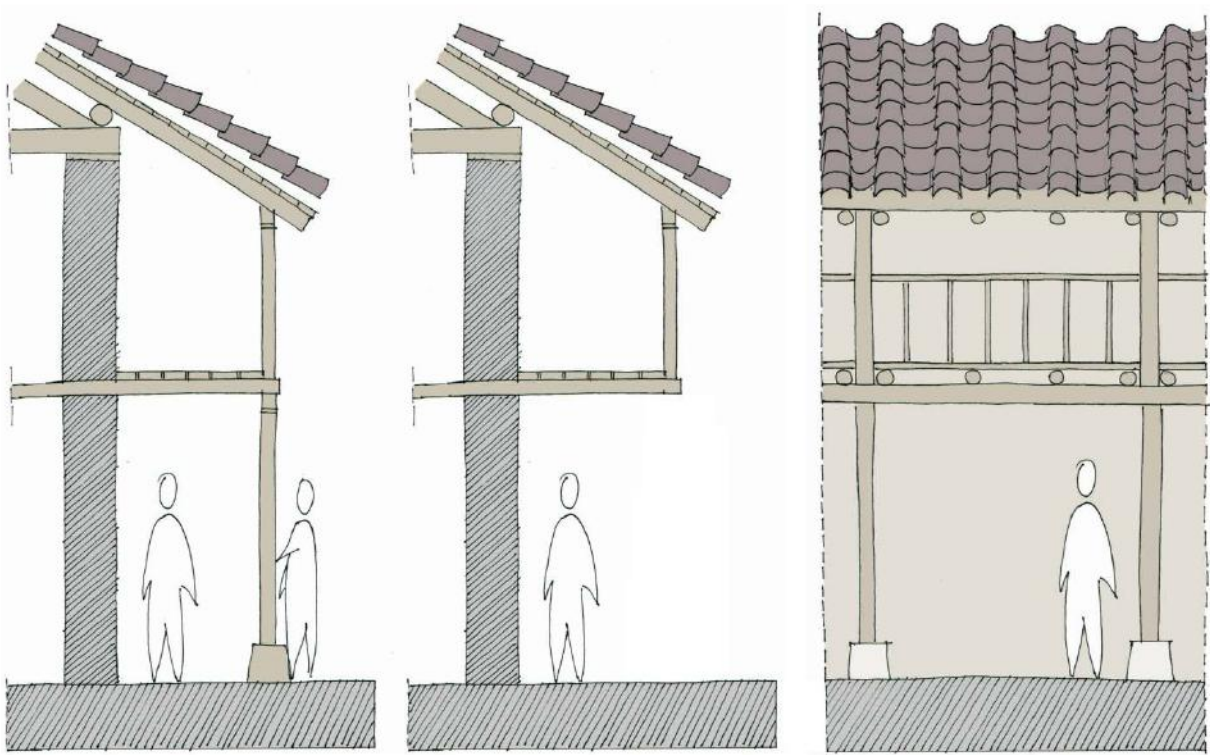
Balcón con solana empleado para uso social. A) Pórtico y corredor. B) Variante en voladizo. C) Alzado soportes superiores sobre inferiores.
